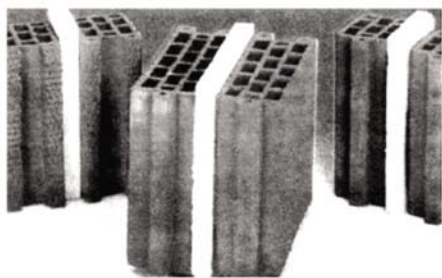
Конструкция из керамических пустотных блоков и пенополистирольного утеплителя
